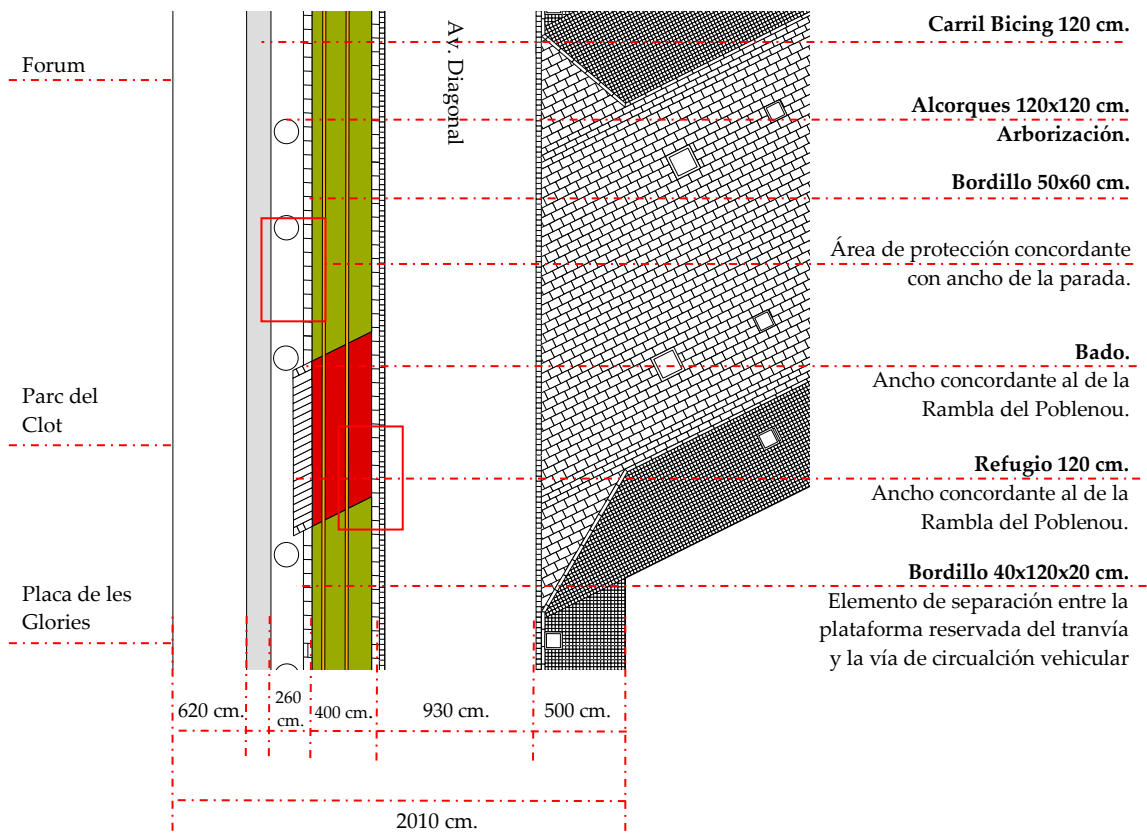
Planta de detalle D. Fuente: elaboración propia.
